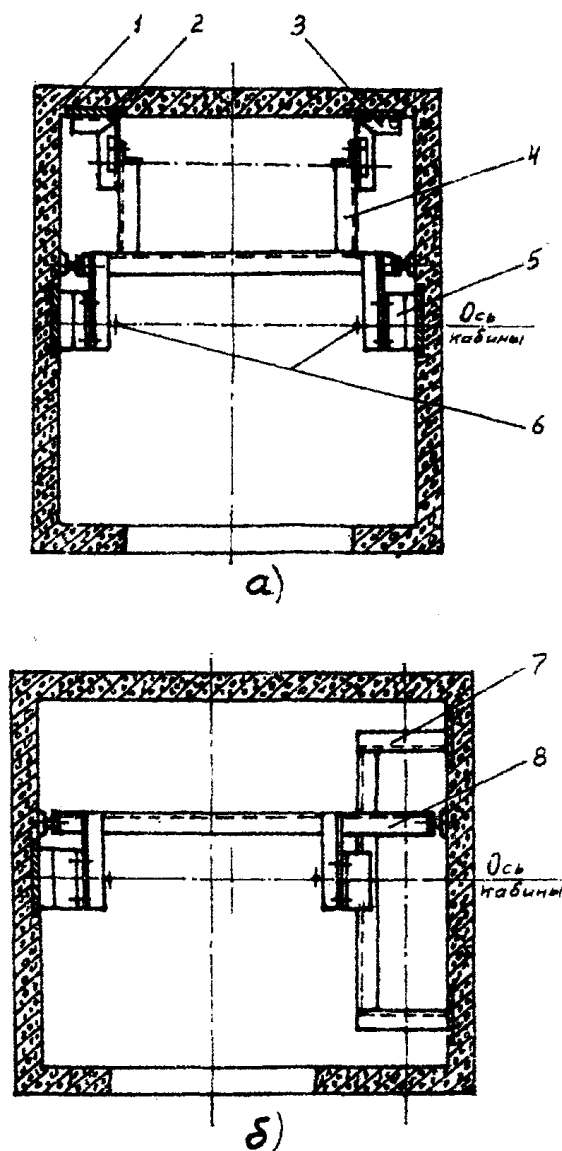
Кондукторы для установки кронштейнов крепления направляющих:
